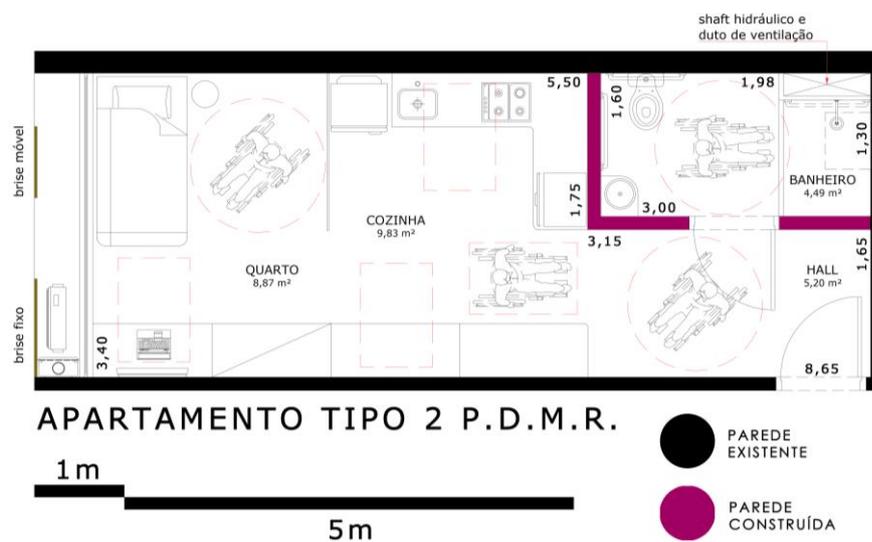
Planta tipologia 02 (produzido pela autora)
